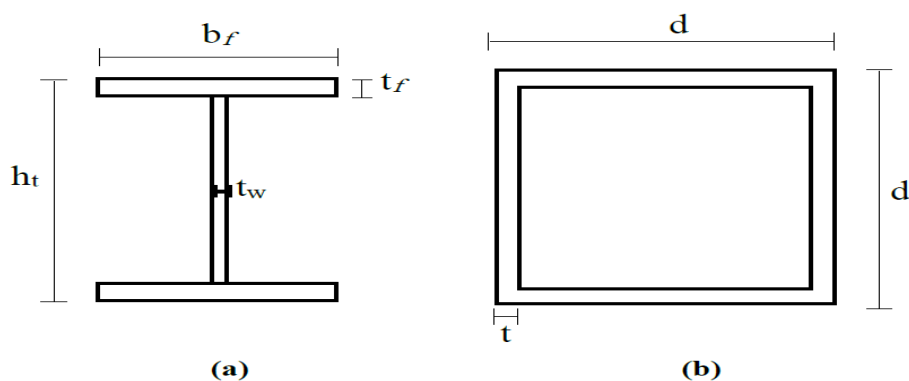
Types des sections utilisées, (a) poutres, (b) poteaux.
